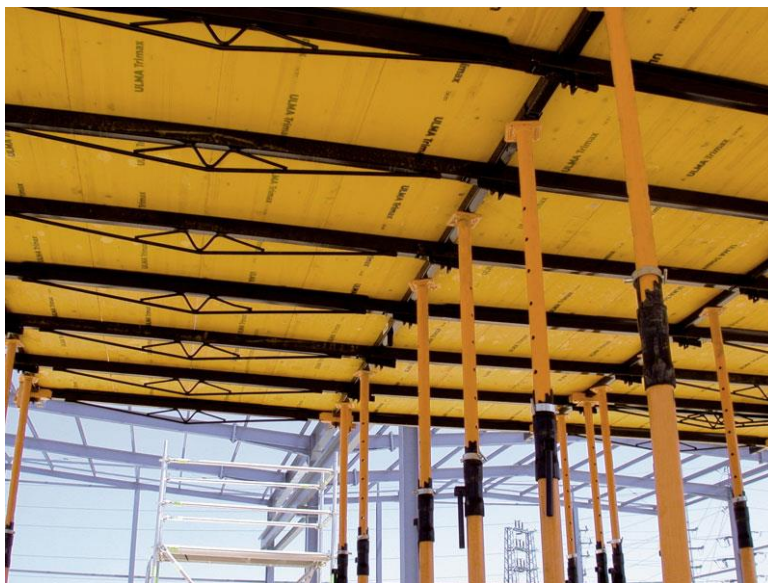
Sistema Racionalizado Recuperável de Painéis para Lajes em Betão [9]
